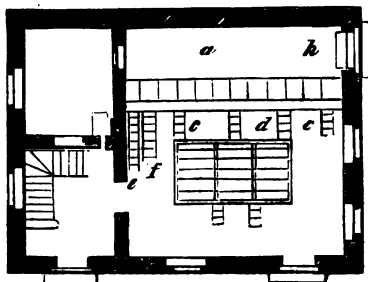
Hühnerhaus mit Nestereinrichtung; Grundriß.
